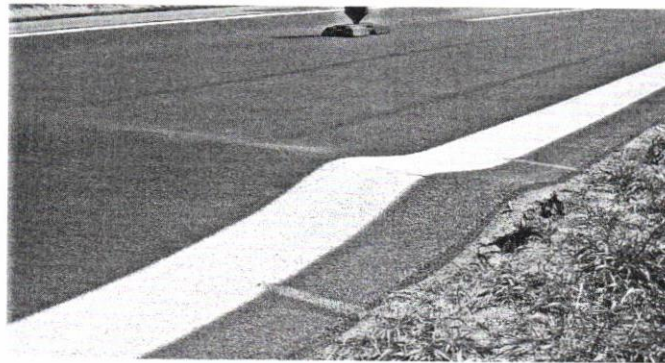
Verwerfung in der Asphaltdecke durch Längs-spannungen in der verbliebenen und dickenre-duzierten Betondecke
